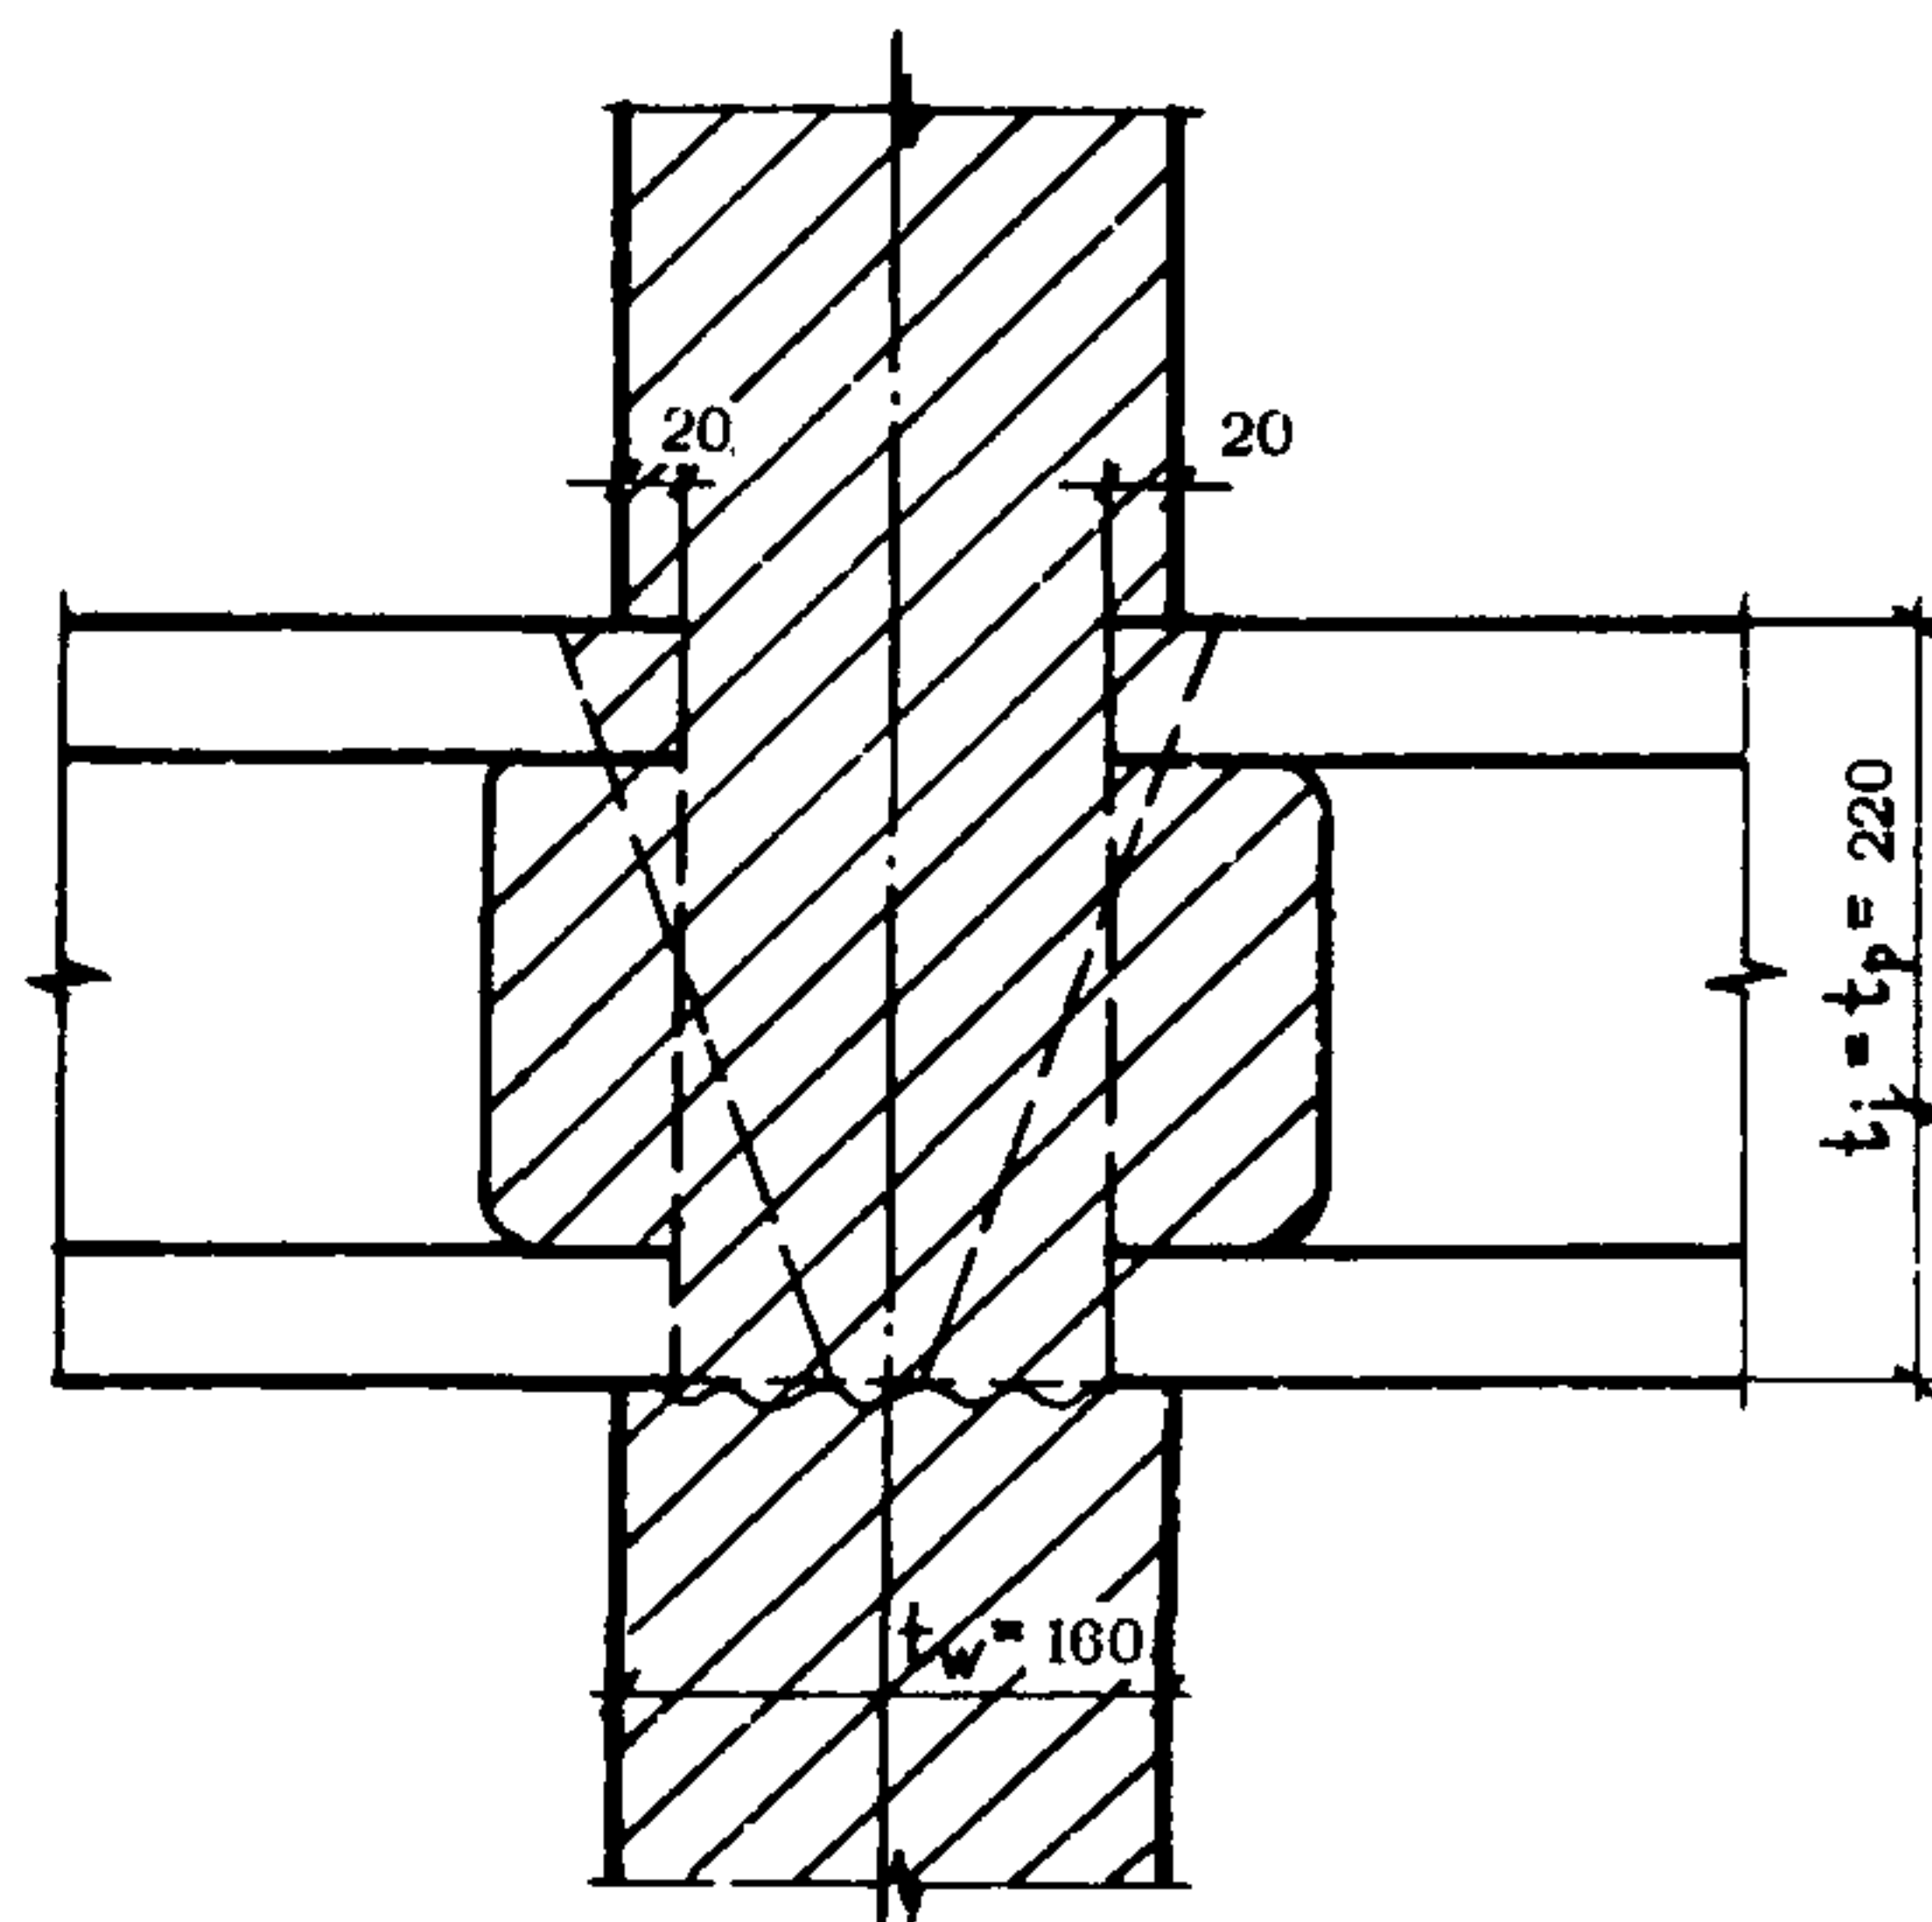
Стык монолитной стены с плитами перекрытий, опертными на две стороны (к примеру 6)
